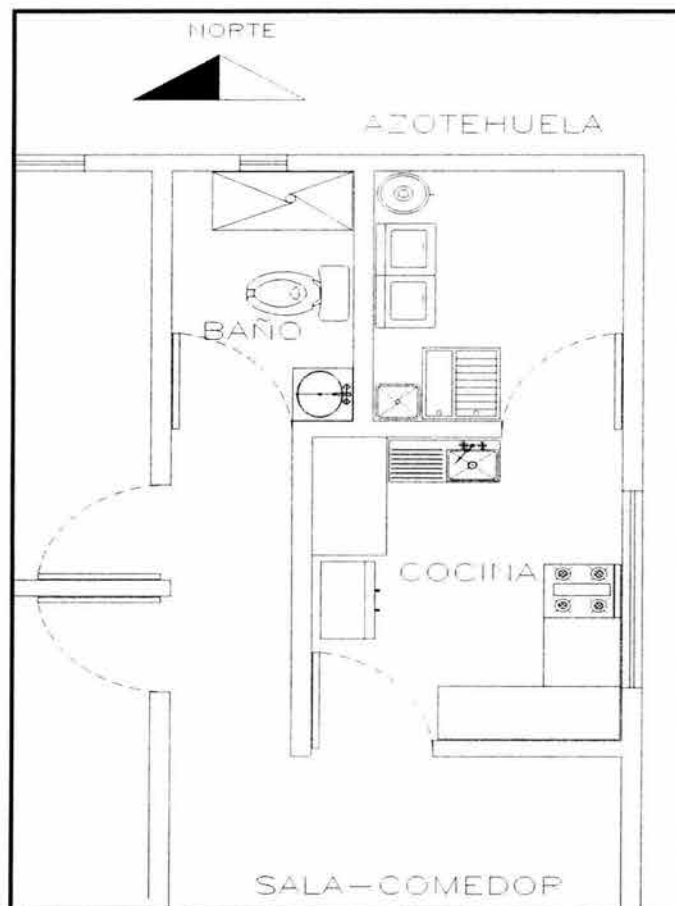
Planta arquitectónica parcial del departamento tipo
